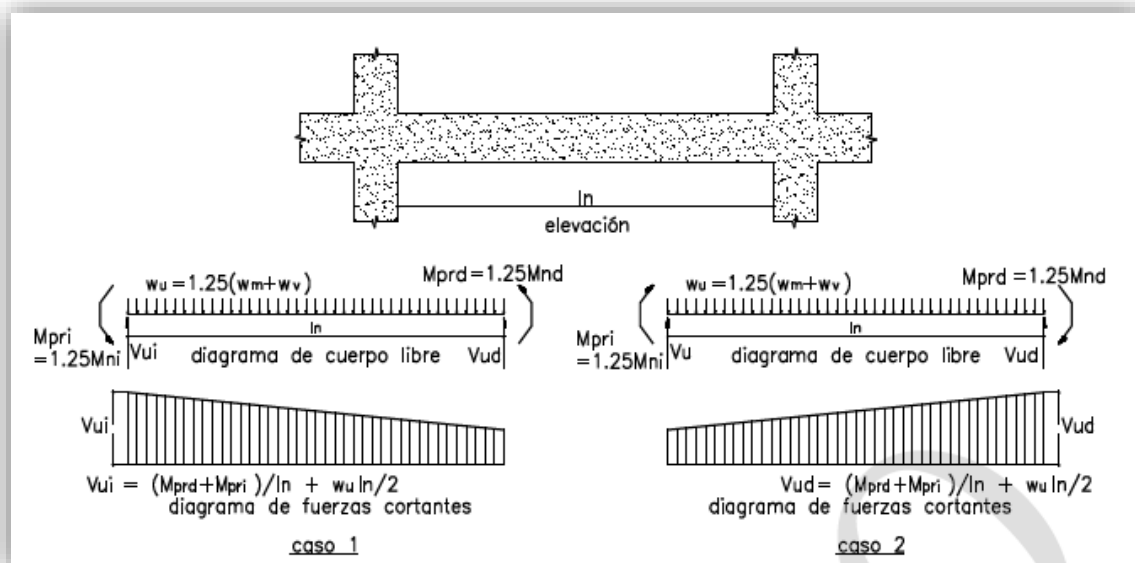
Fuerzo cortante de diseño en vigas
